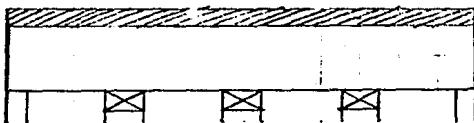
(b). Sección Compuesta apuntalada
